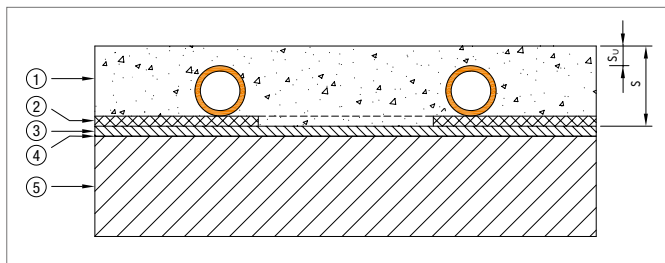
Prinzipaufbau Klettsystem RAUTHERM SPEED plus renova
